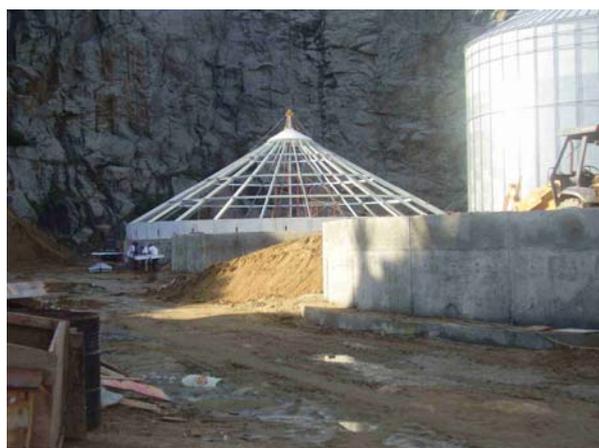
ARMAZÉM ALFANDEGADO EM CONSTRUÇÃO
